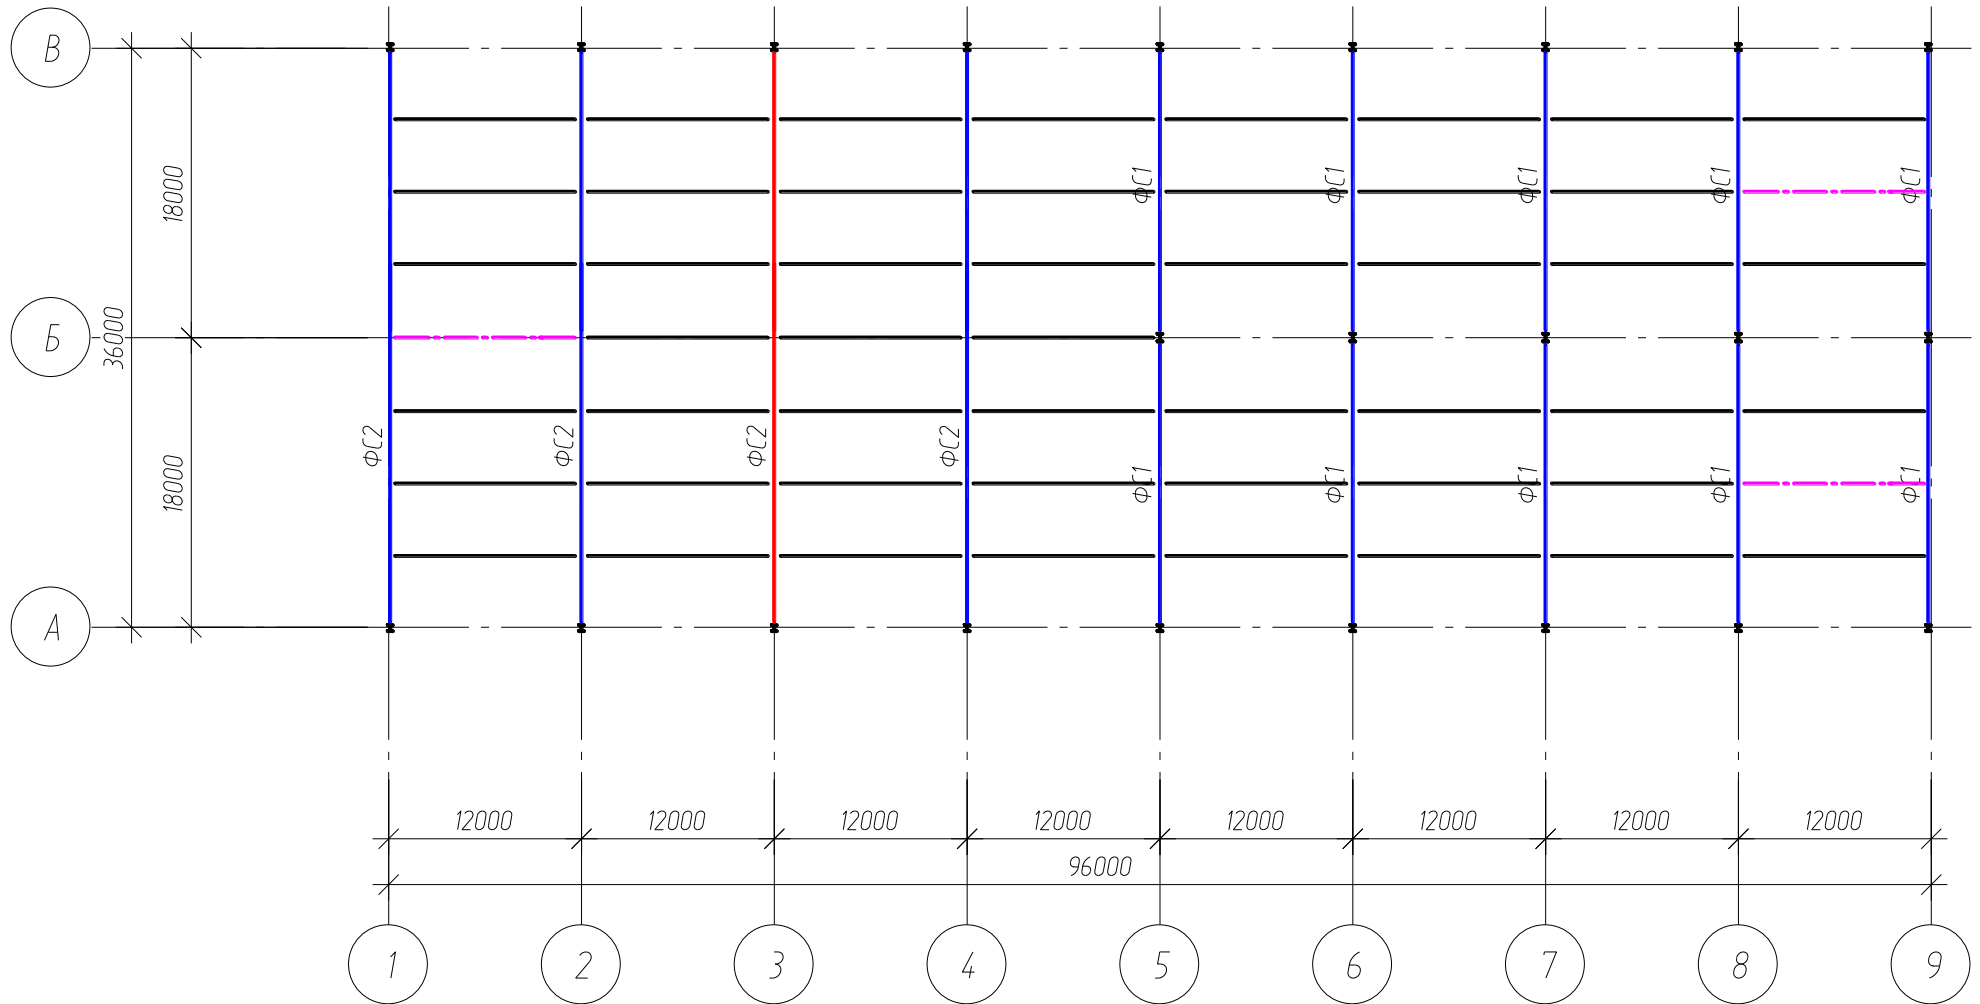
«Схема расположения связей и распорок по нижним поясам ферм» [14]
